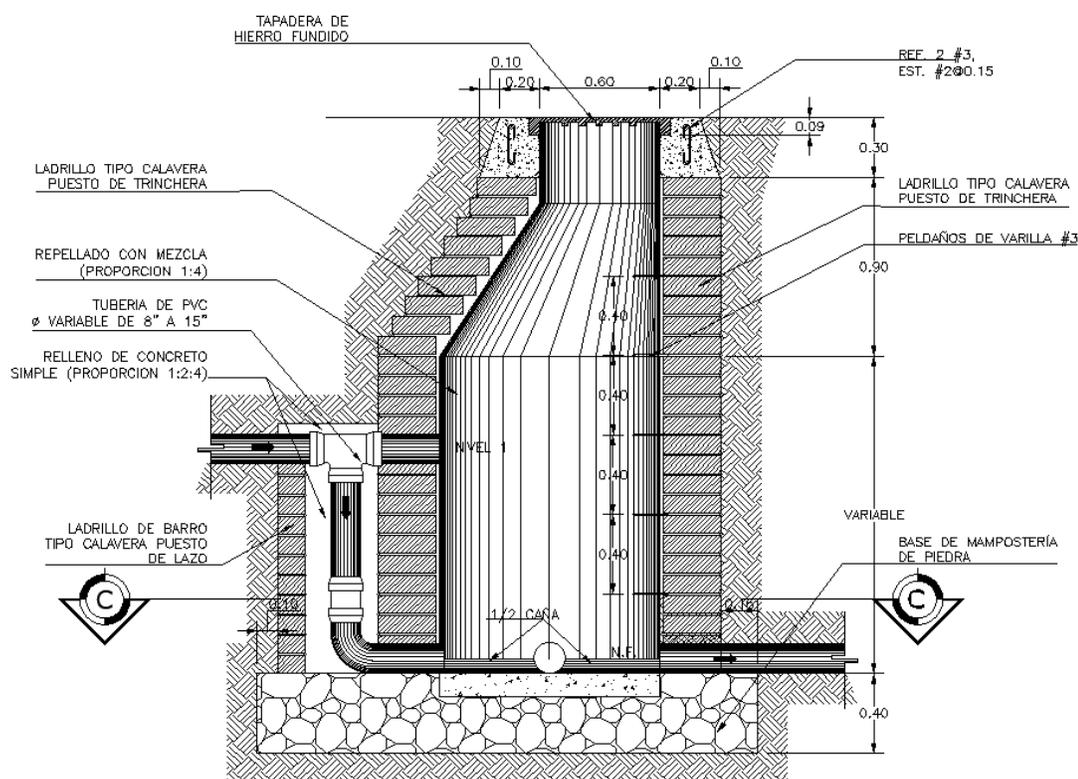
1 detalle en elevación de un pozo de visita con caja de sostén
